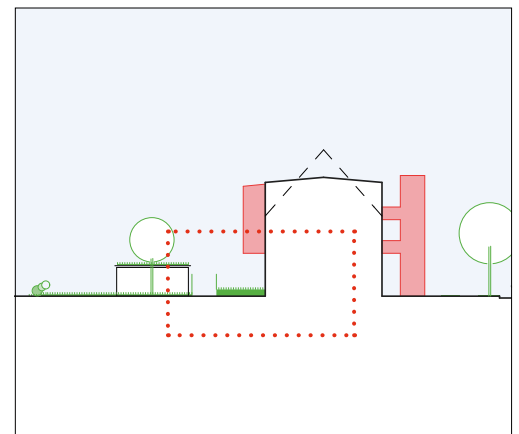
Blockstufe als Kante, Detailschnitt Dachau
